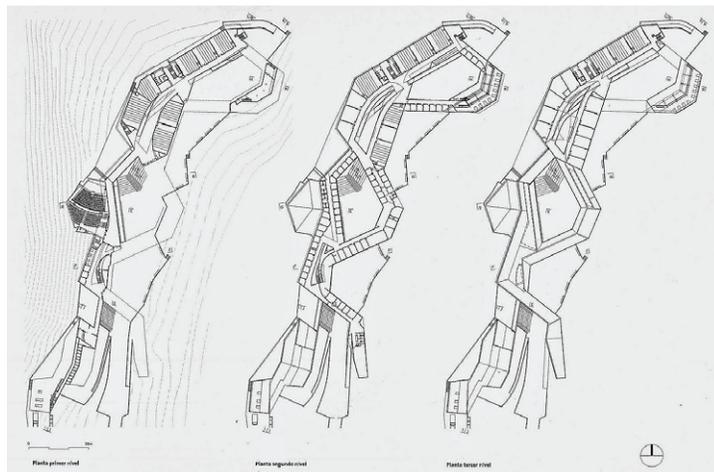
Planta primer, segundo y tercer nivel. Universidad Adolfo Ibáñez: Fuente: Bennett E, Crispiani A, editores. José Cruz Ovalle: hacia una nueva abstracción, 2004.
